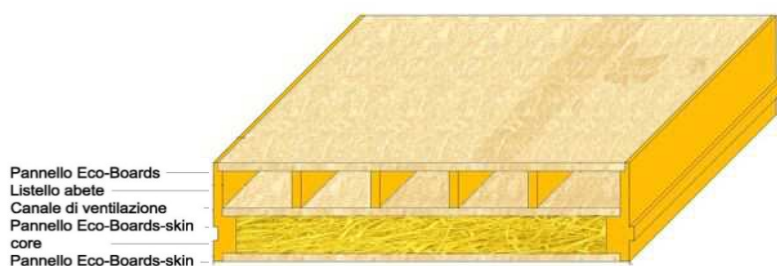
Modello 3d del sistema STRAWind. Elaborazione dell'autore
